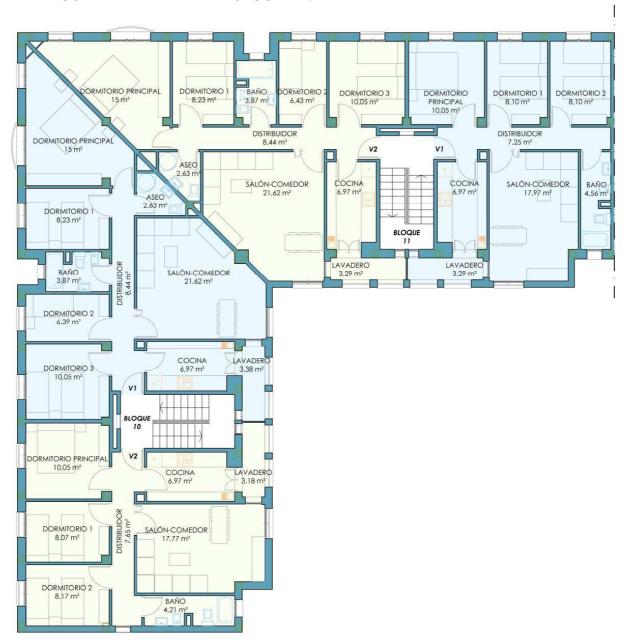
Plano Planta Primera y Segunda; bloques 10 y 11.15
